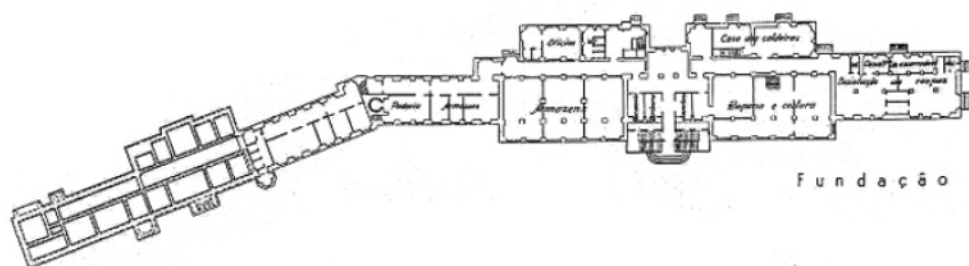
Planta de Fundação / piso térreo do Sanatório de Penhas de Saúde – sem escala
